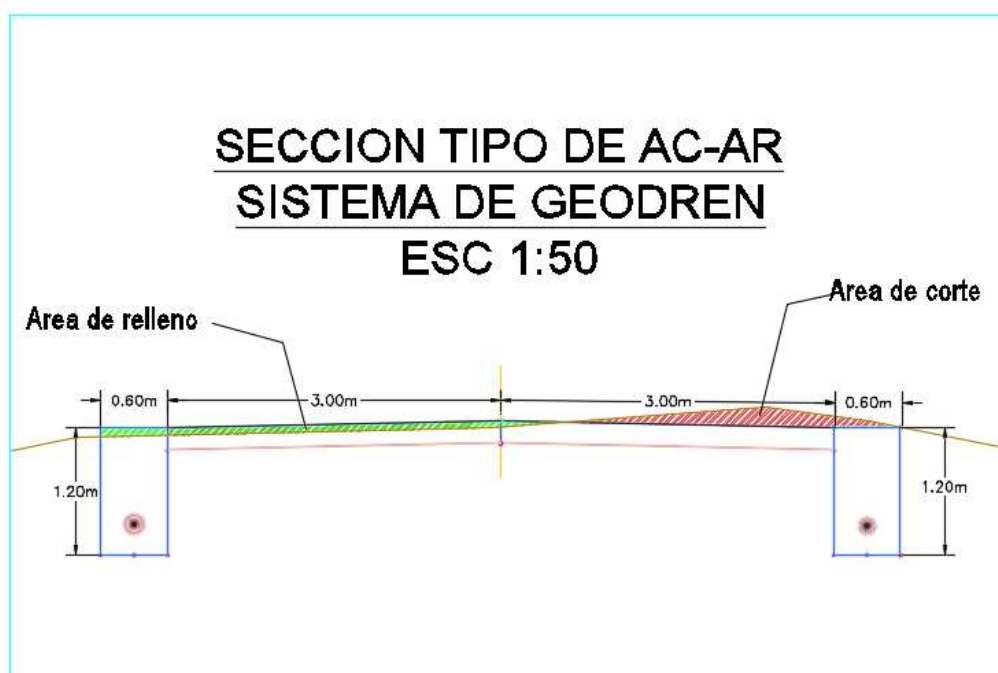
Sección típica final del sistema de subdrenaje Geodren.
